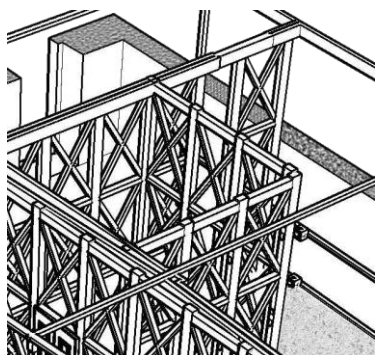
Vista Lateral Esquerda com corte vista de corredor, apartamento sem paredes exteriores, em corte vertical, expondo tipo construtivo, criação do autor.
